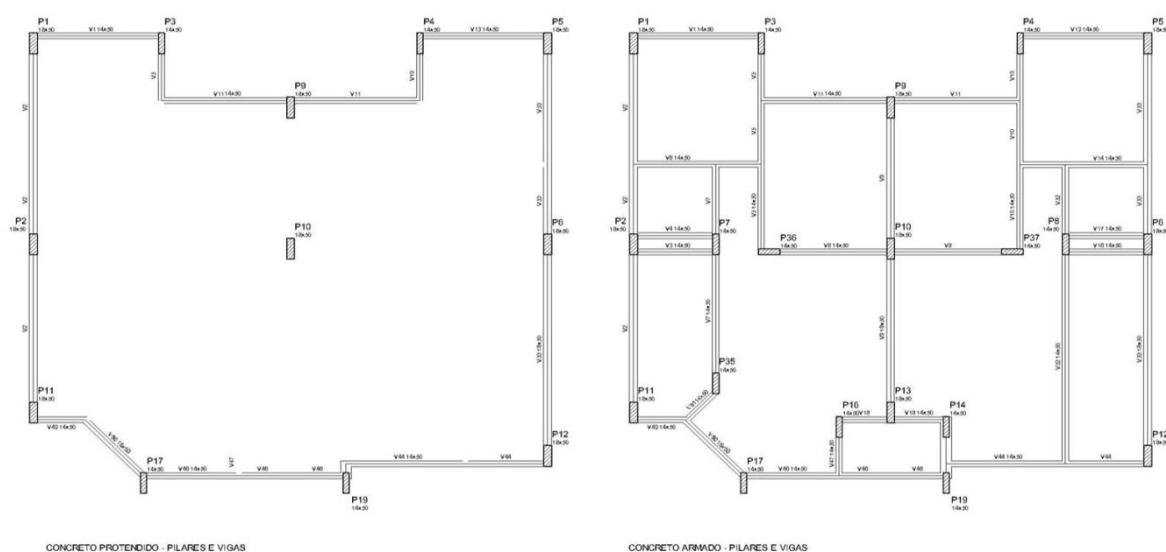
DISPOSIÇÃO DE PILARES E VIGAS PARA CP E CA
